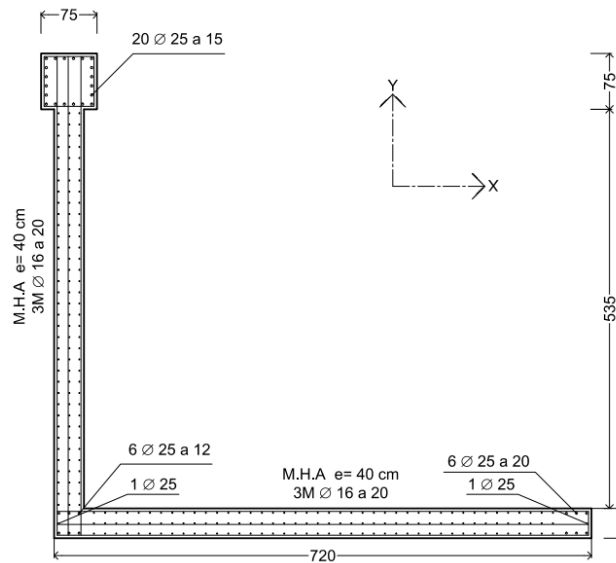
Distribución de la armadura longitudinal muro 1.
